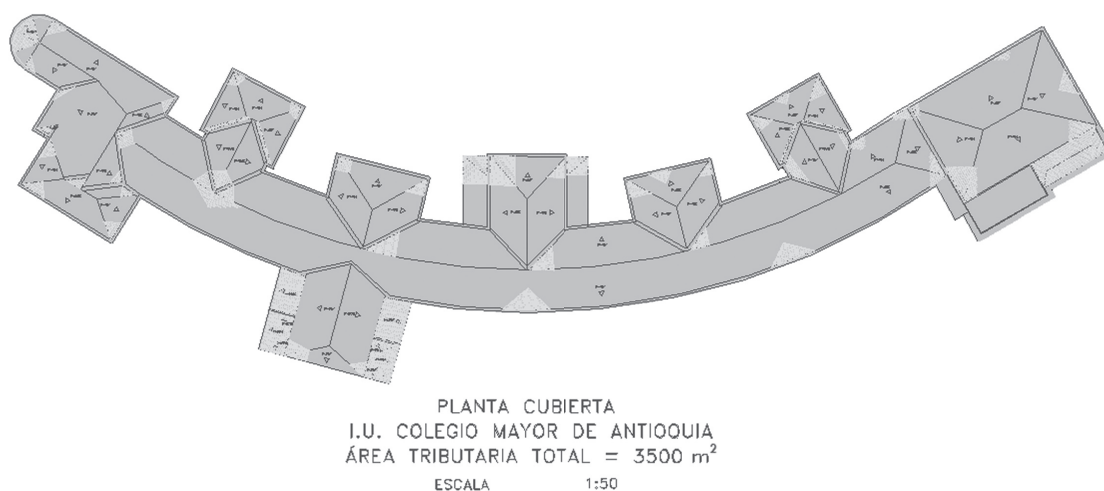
Plano planta de cubiertas de la I. U. Colegio Mayor de Antioquia
